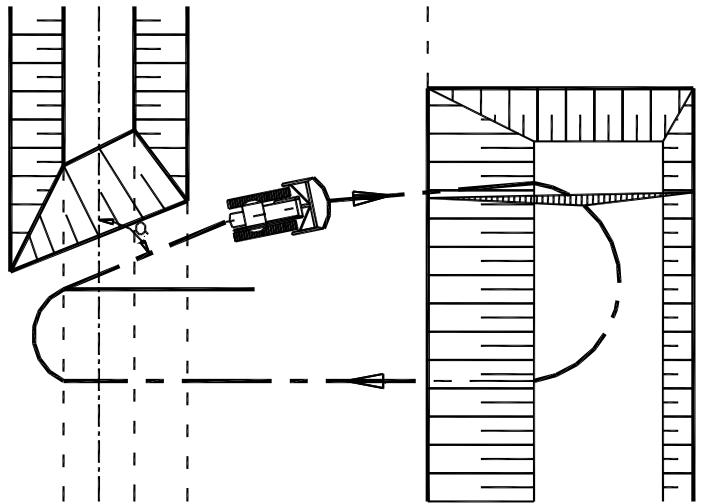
Схема перемещения бульдозером ранее разработанного грунта
